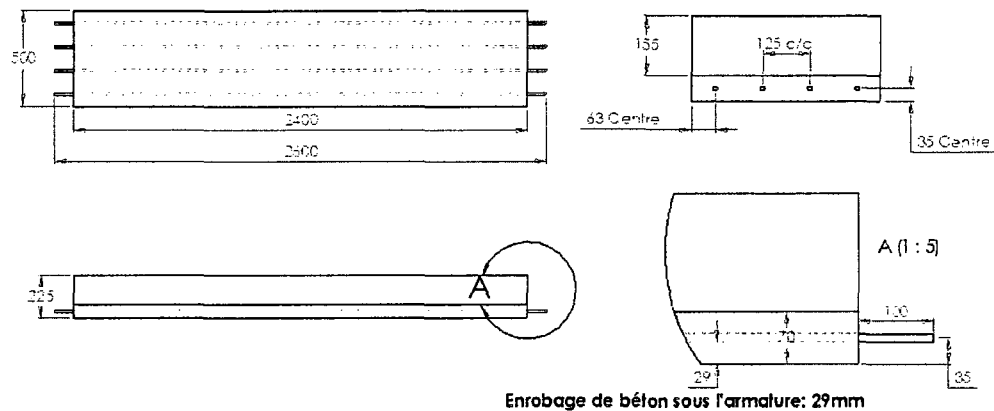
Plan du système pré-dalle/dalle BFHP50
